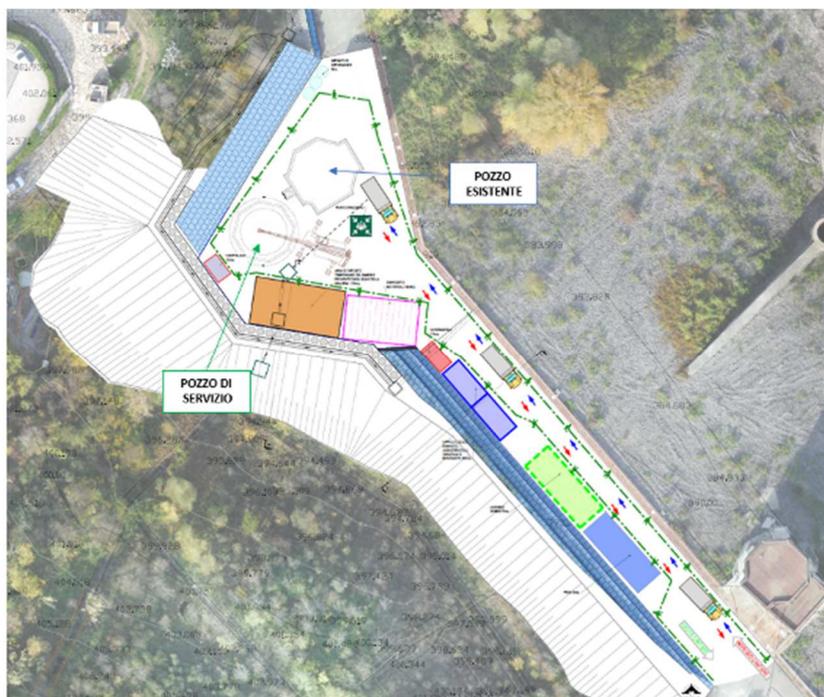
Layout cantiere pozzo di servizio e collegamento alle preesistenti opere di presa
